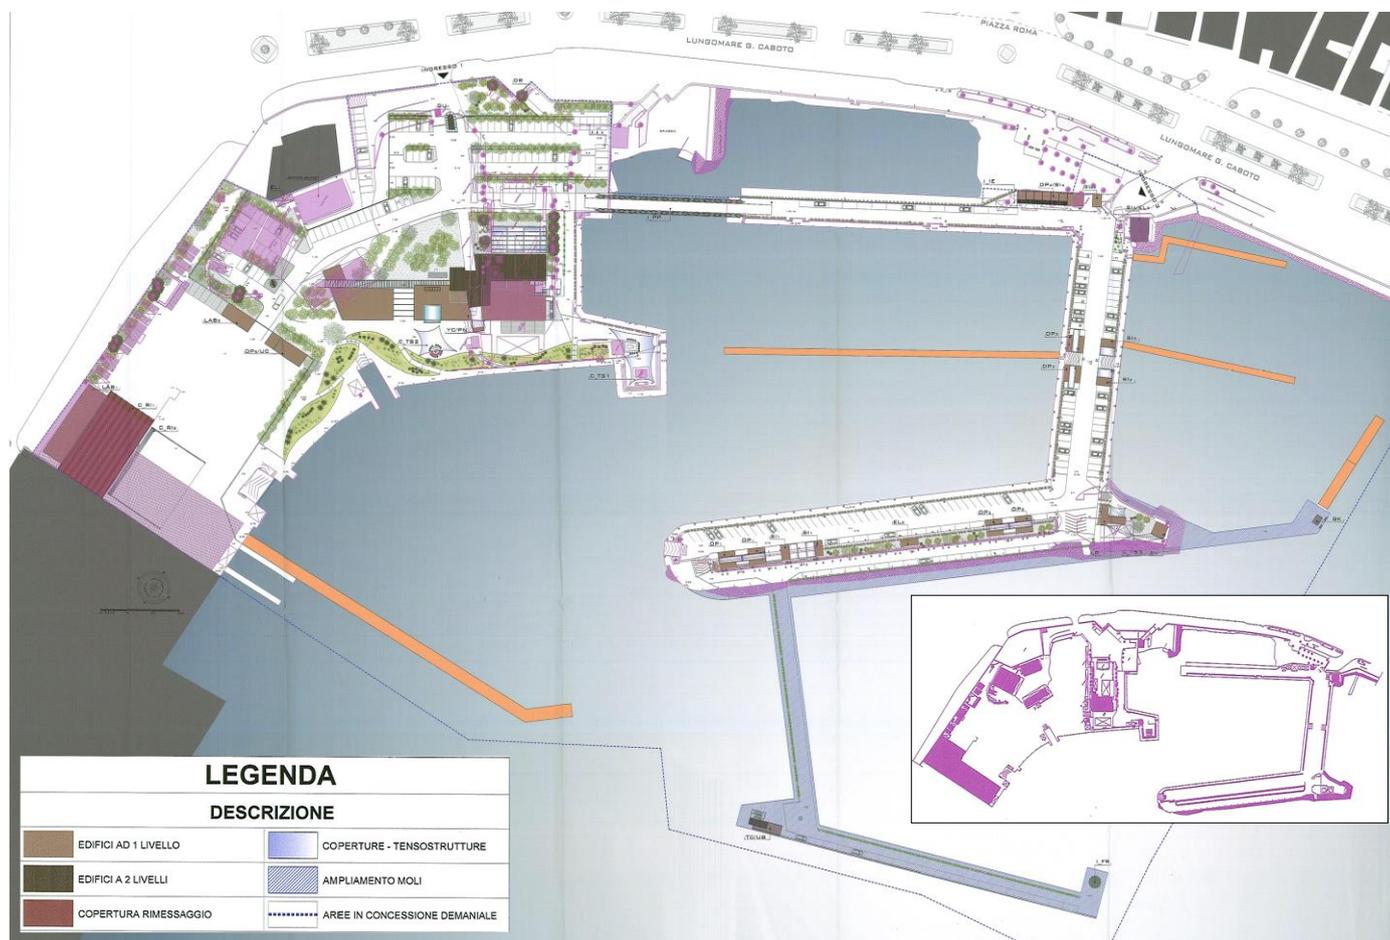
Planimetria dello stato attuale (a destra nel riquadro e in viola sotto la figura grande) con sovrapposizione del progetto
